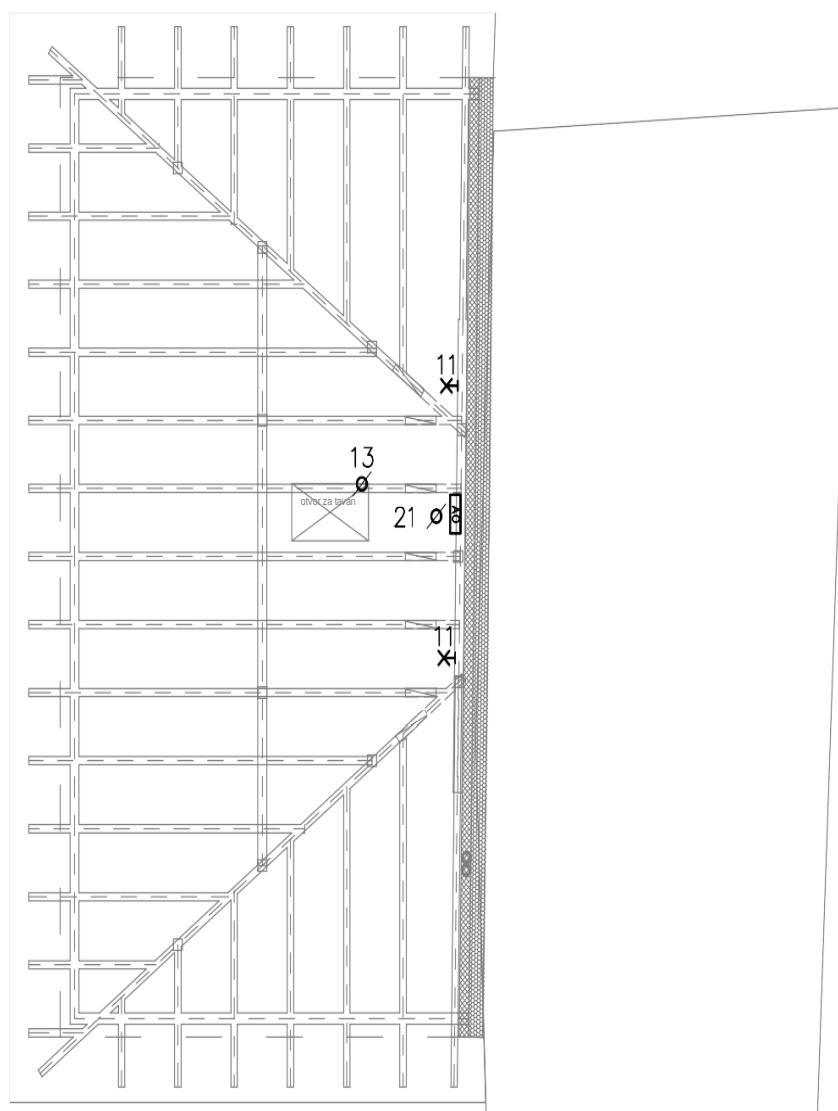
Elektroinstalacija snage i slabe struje - kat
